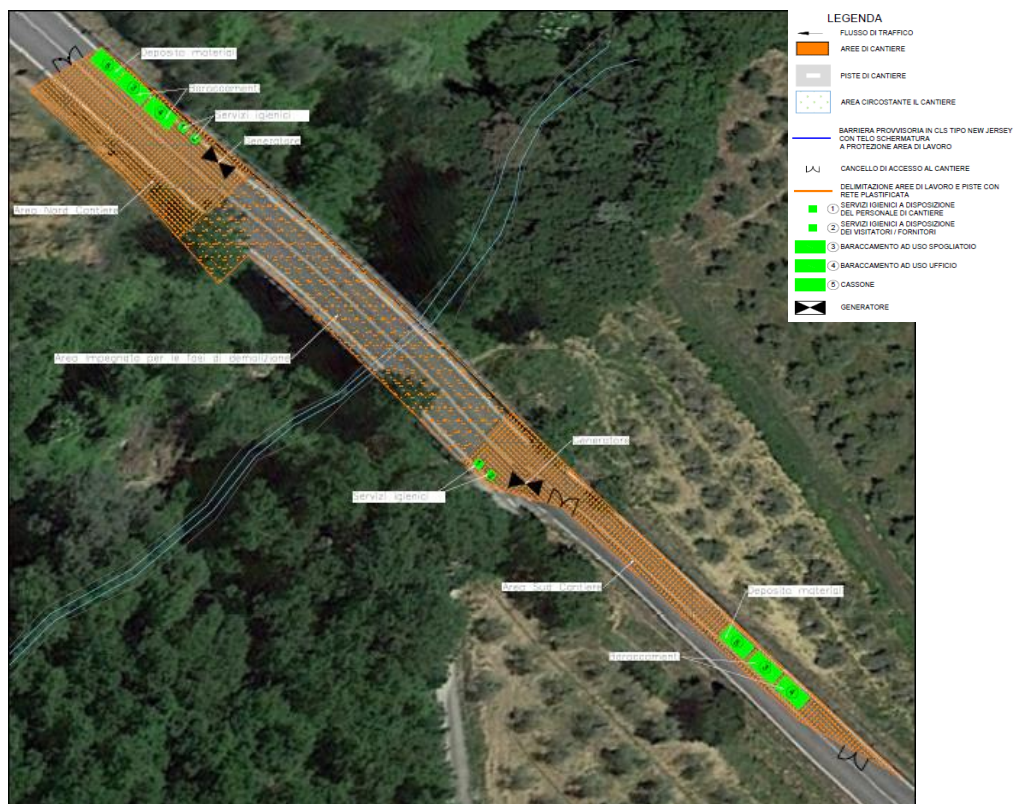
Cantiere Fase 2a: Demolizione ponte esistente, realizzazione elevazioni nuove spalle.
